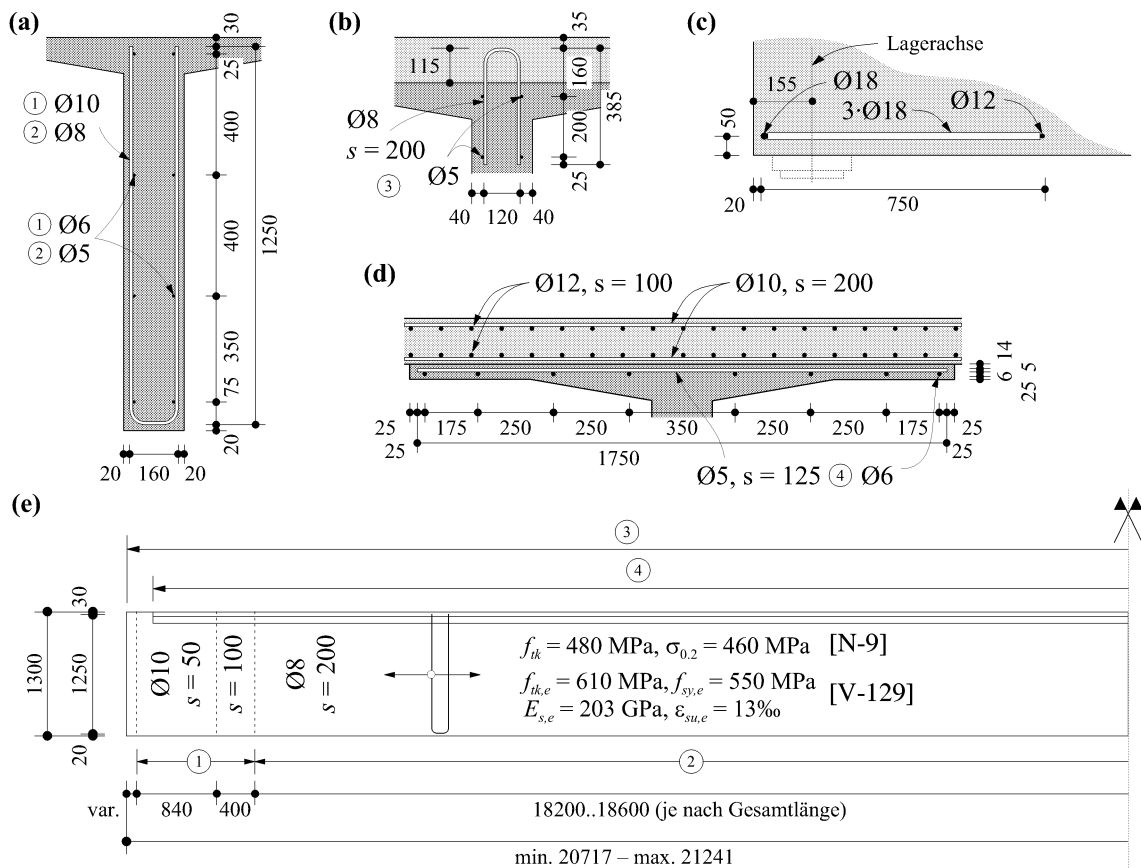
Lehnenviadukt Wassnerwald, [mm] – Schlaaffe Bewehrung: (a) Stegbewehrung; (b) Anschlussbewehrung; (c) Auflagersicherung; (d) Flanschbewehrung Fertigteilträger und Bewehrung Ortbetonplatte und (e) Anordnung der Netzbewehrungen über die Länge.
